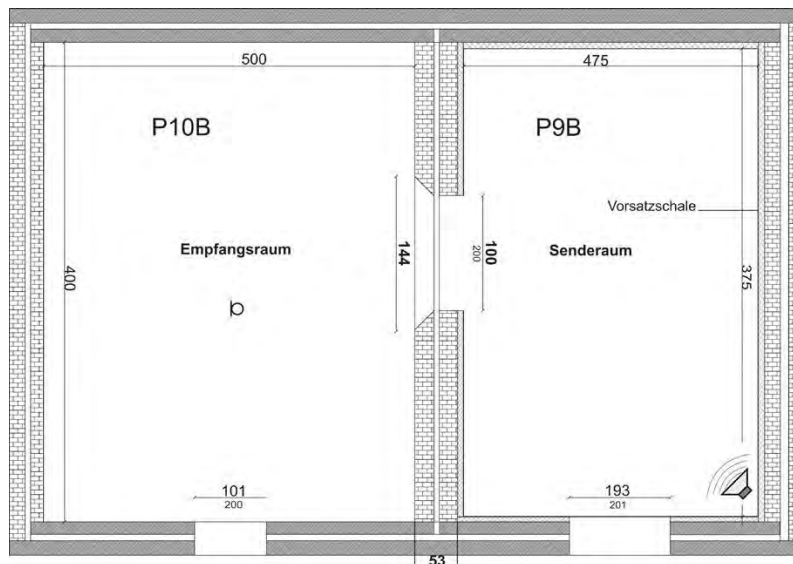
Grundriss des Türprüfstandes [88]
